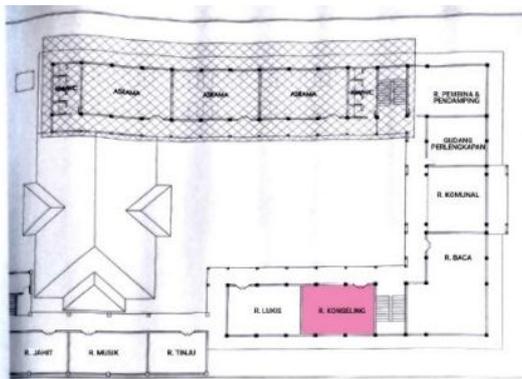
Denah lantai 1 dengan penerapan Kebutuhan Transeden
